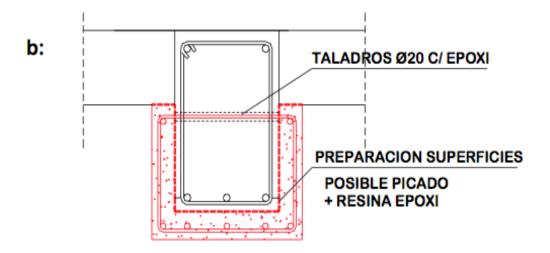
Armados para refuerzo de vigas caso b. (Fuente: Patología, reparación y refuerzo de estructuras de hormigón armado de edificación)
